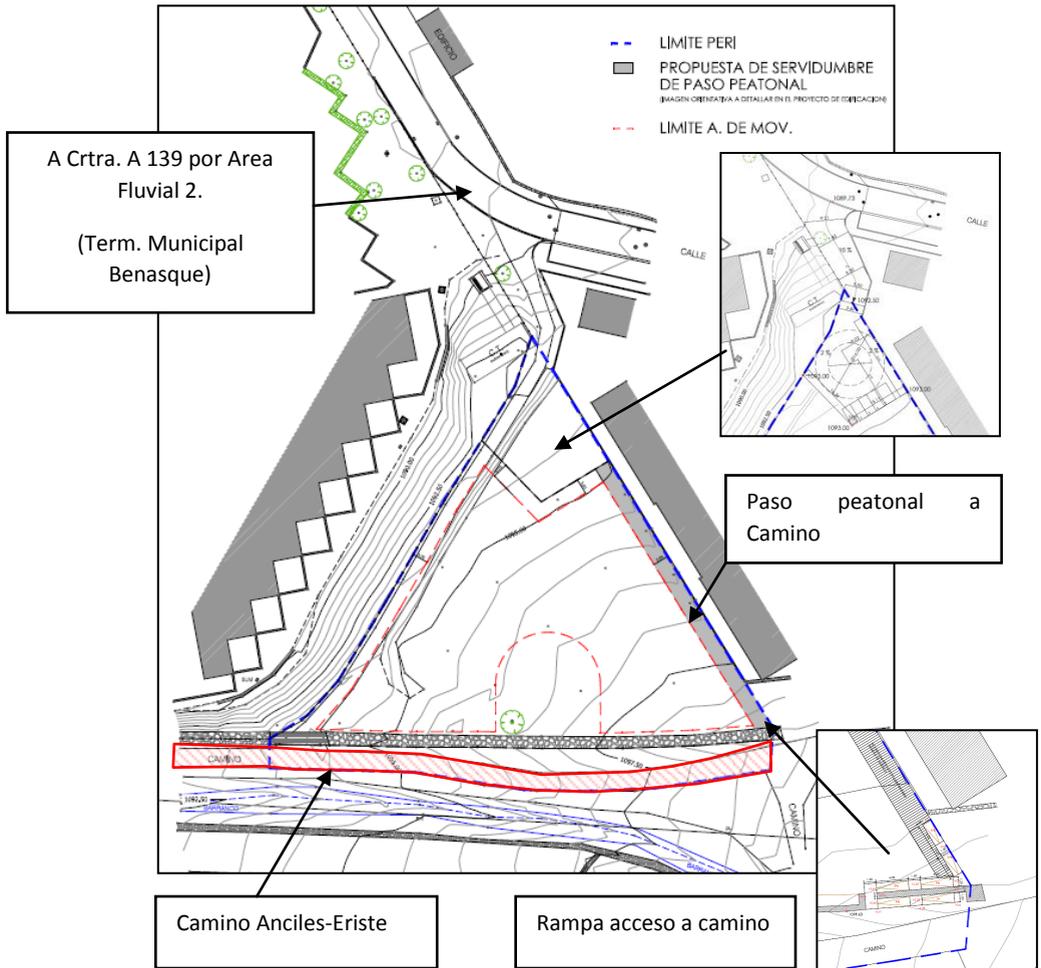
Accesos a PERI 3 “Eriste”, 2017, Plano o.11 Texto Refundido PERI 3.
